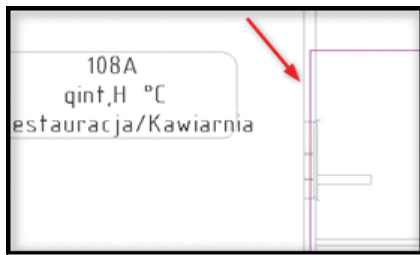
Przykład źle narysowanego dachu (opracowanie własne)
